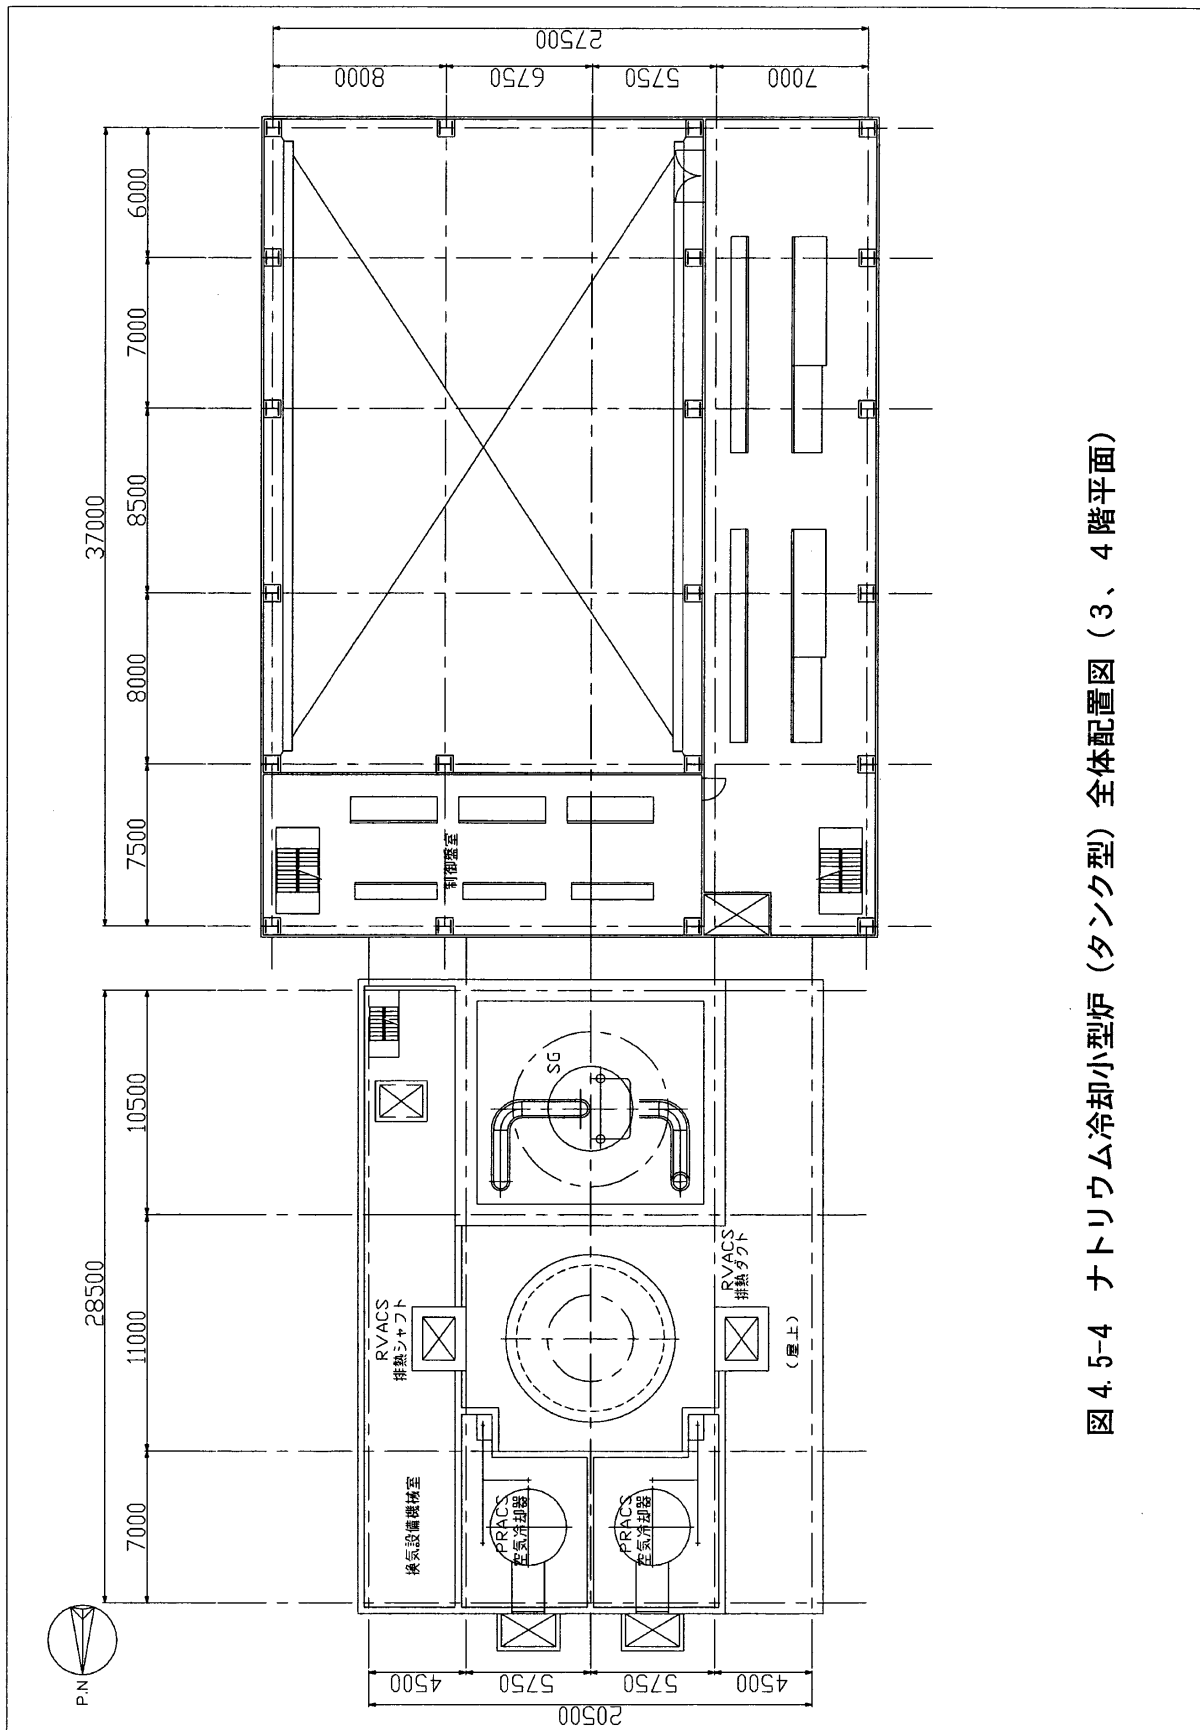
ナトリウム冷却小型炉 (タンク型) 全体配置図 (3、4 階平面)
